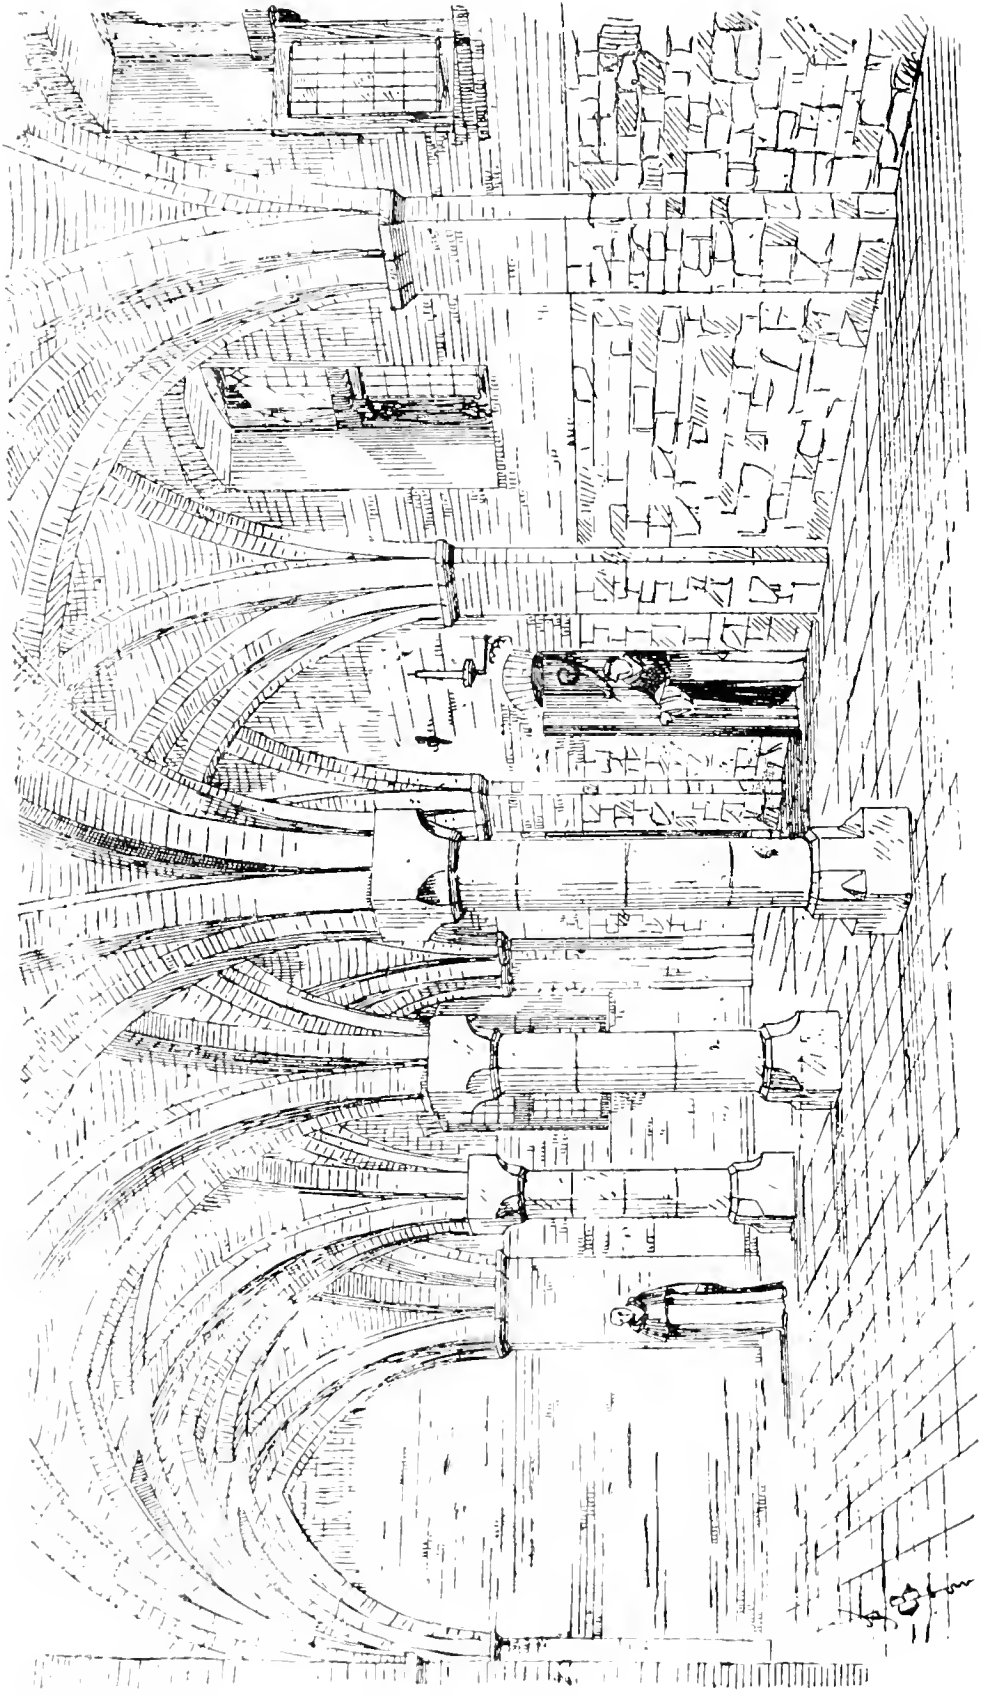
Salle du rez-de-chaussée. Restauration.
